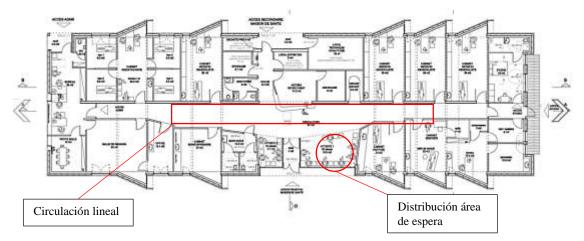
Planta centro clínico Adaptado de (Nicolas Waltefaugle, Olivier Jouanneau, 2009)
